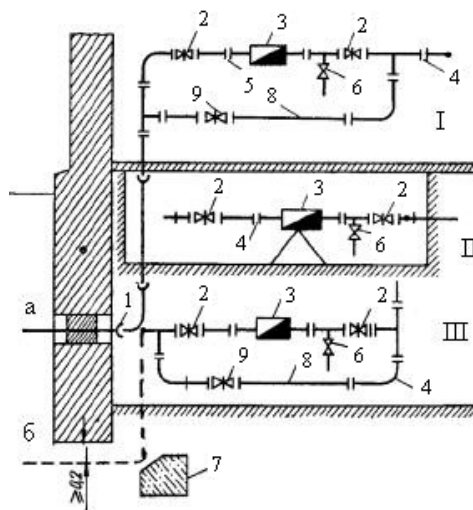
Схеми влаштування введів у будинок і монтажу загальних водомірних вузлів: а - прокладання труби вводу через фундамент; б - прокладання труби вводу під фундаментом; монтаж водомірного вузла: I - на першому поверсі; II - у монтажному колодязі; III - у підвалі; 1 - ввід водопроводу; 2 - запірні арматура; 3 - водолічильник; 4 - монтажне з'єднання; 5 - фільтр; 6 - спускний кран; 7 - підпора; 8 - обвідна лінія; 9 - опломбована засувка
